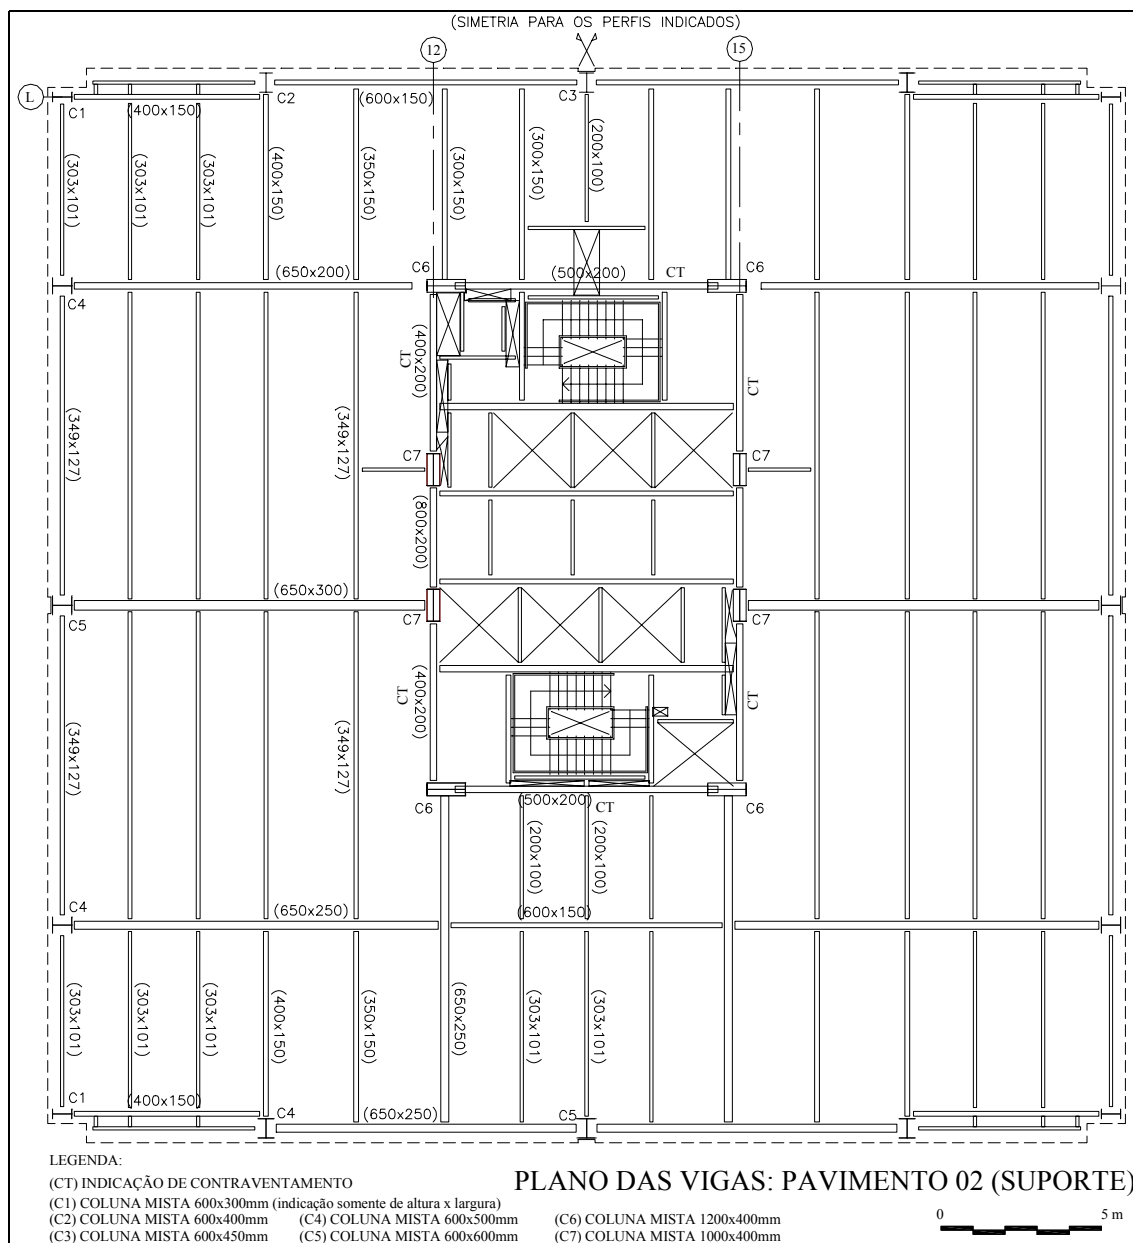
Solução estrutural do edifício E-2: plano das vigas do primeiro pavimento-tipo.
